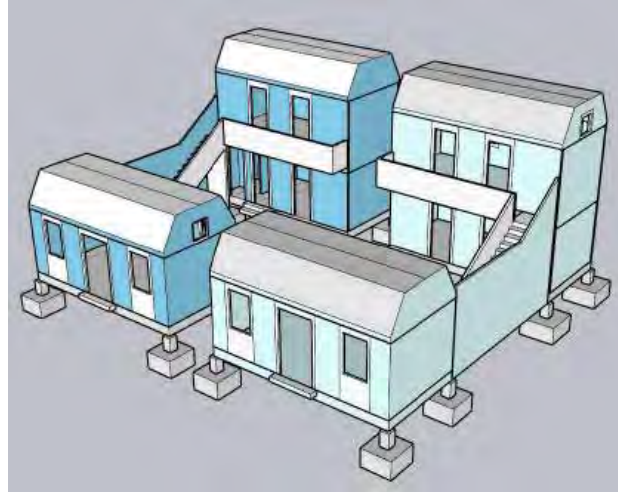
Ejemplo de casa contigua - Casa Upcrete Buena Vista
